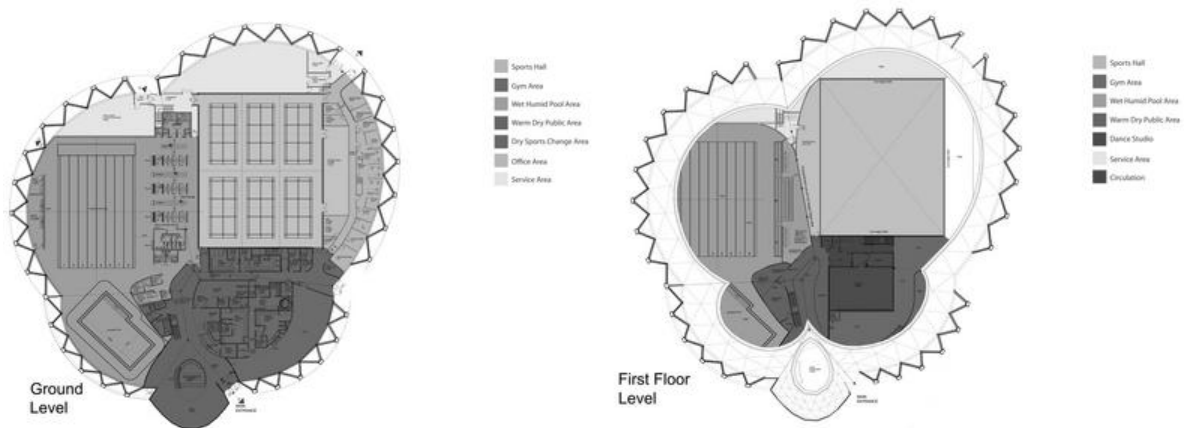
Grundrisspläne und Nutzungszonen (AWA architects)
